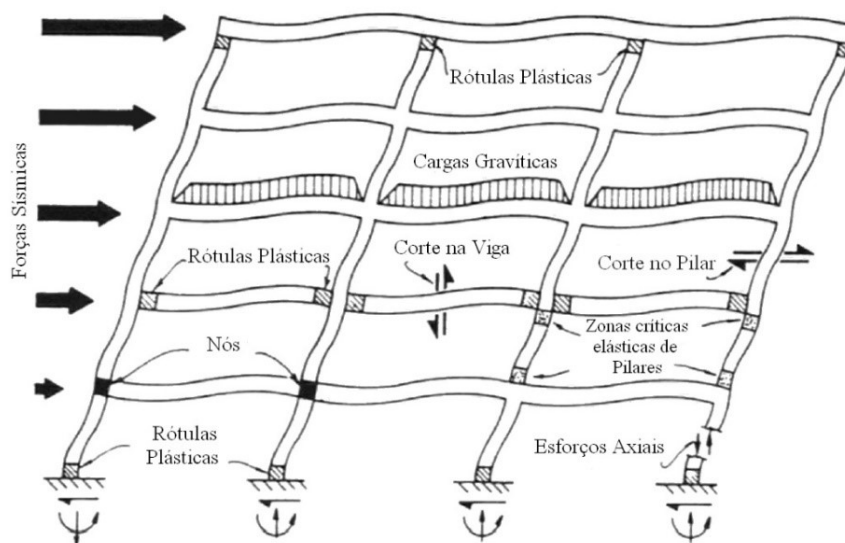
Mecanismo de rótulas plásticas em estruturas porticadas de betão armado.
